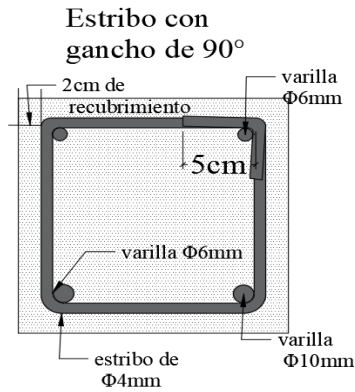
Diseño de Viga con Carga Aplicada.
